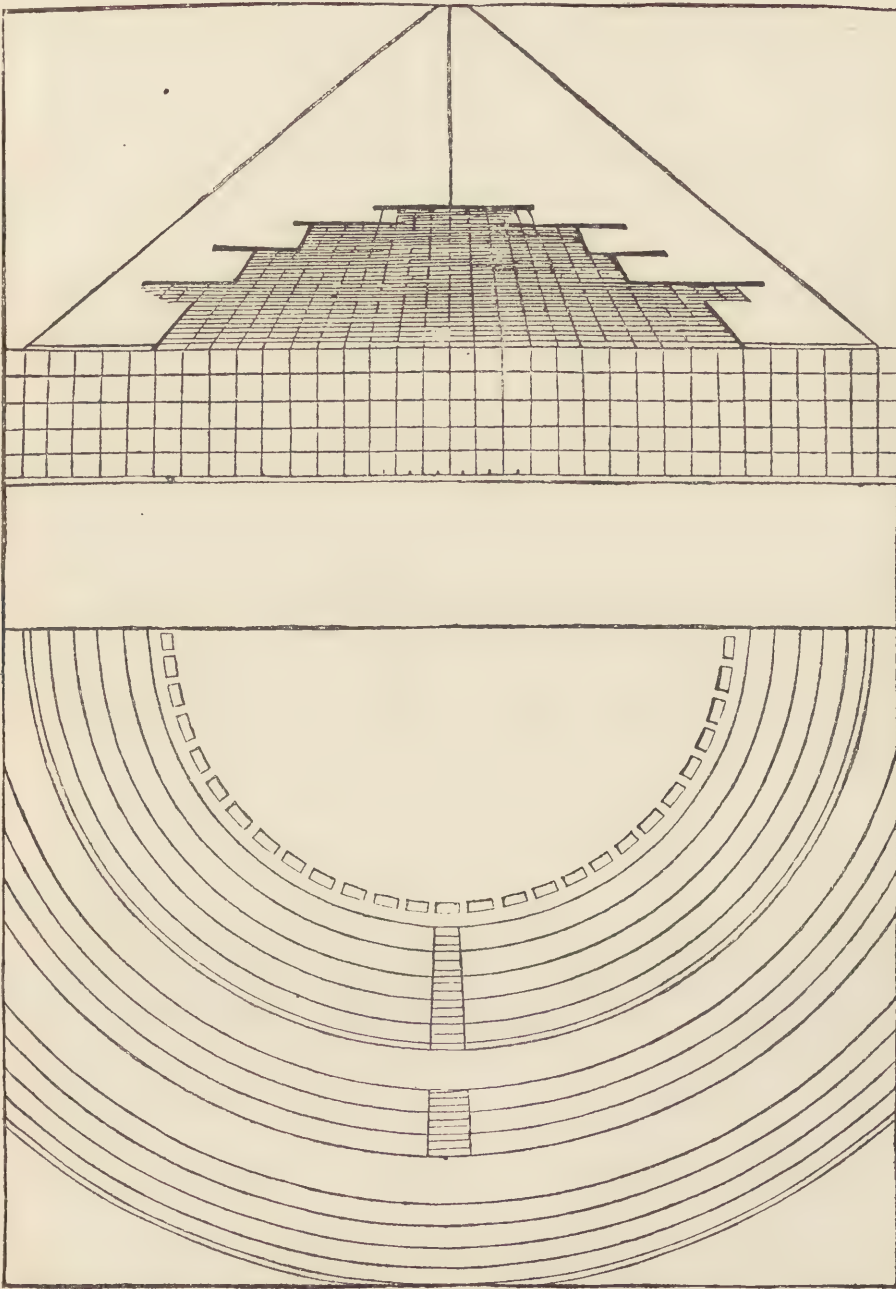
Schema eines Theaters nach Serlio. Grundriss.
